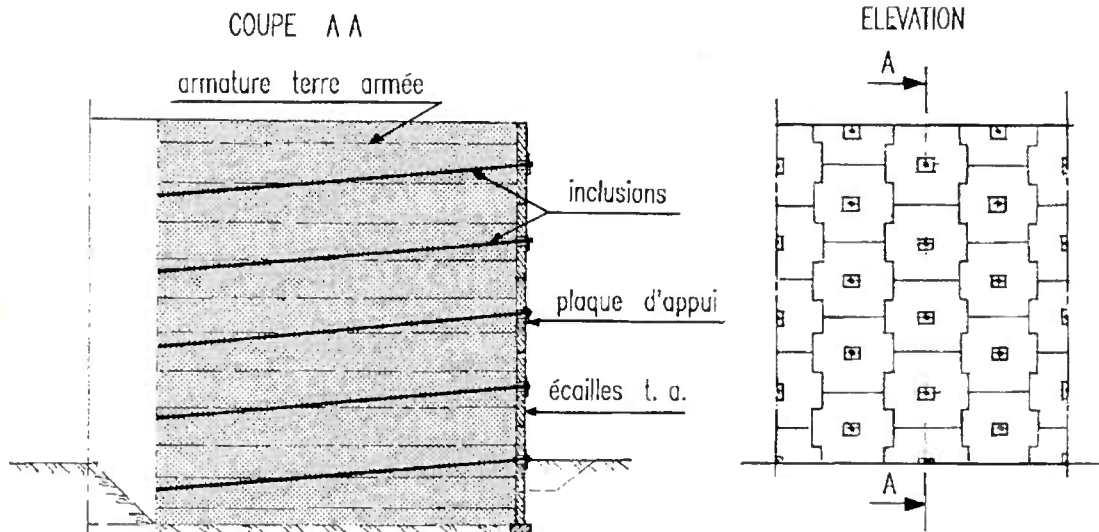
Principe du renforcement d'un mur en terre armée par clouage
